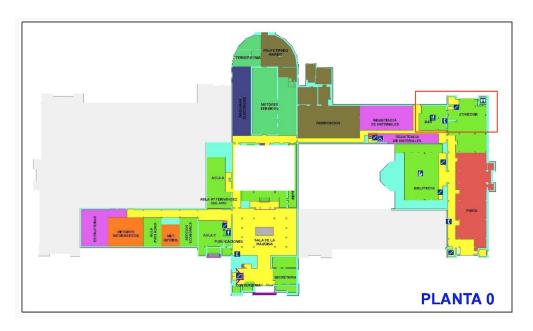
Plano de planta de la ETSII (en rojo la cafetería) (Fuente: Induforum)
